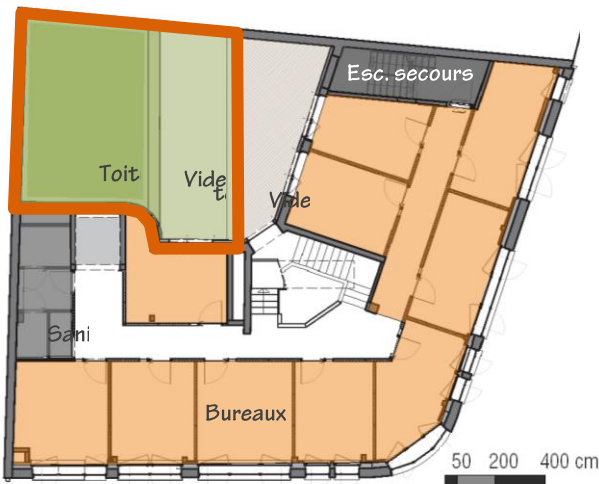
Plan du 1er étage (Source : Bureau A2M, 2011)
